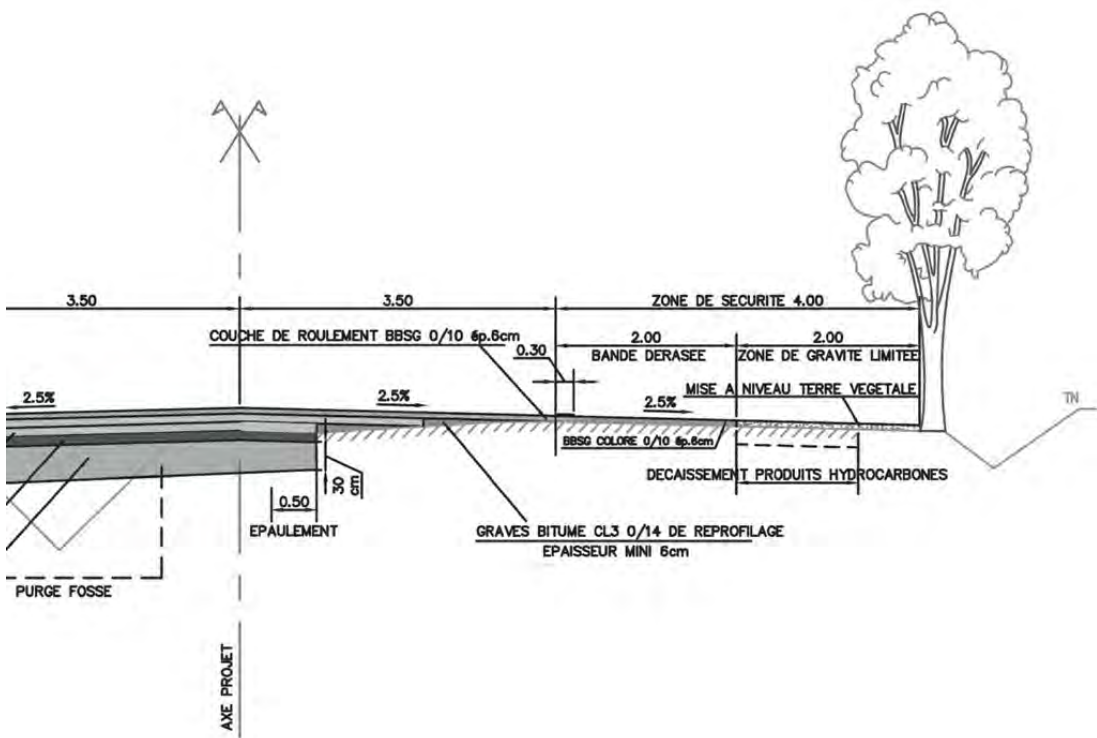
Profil en travers type – Section courante. (Voir cahier couleur p.92-93)
